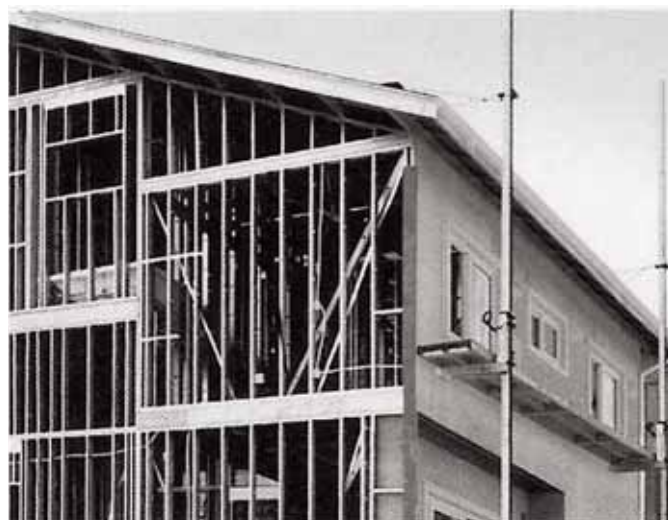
Montagem de residência em Light Steel Framing, São Paulo- SP (Fonte: Construtora Seqüência)
